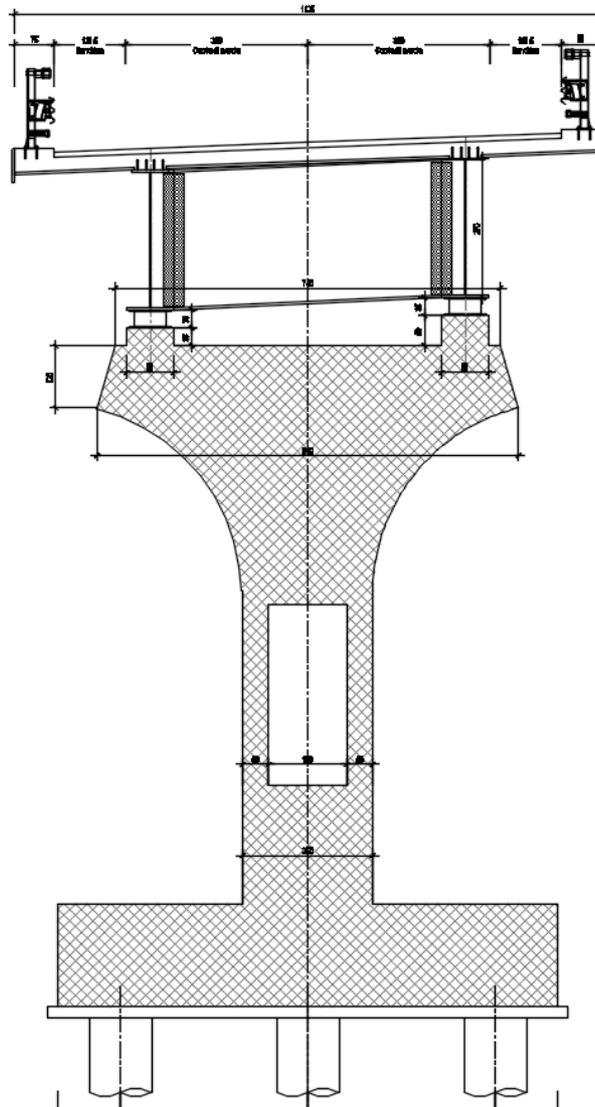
Viadotto Firenzuola – Sezione su pila
